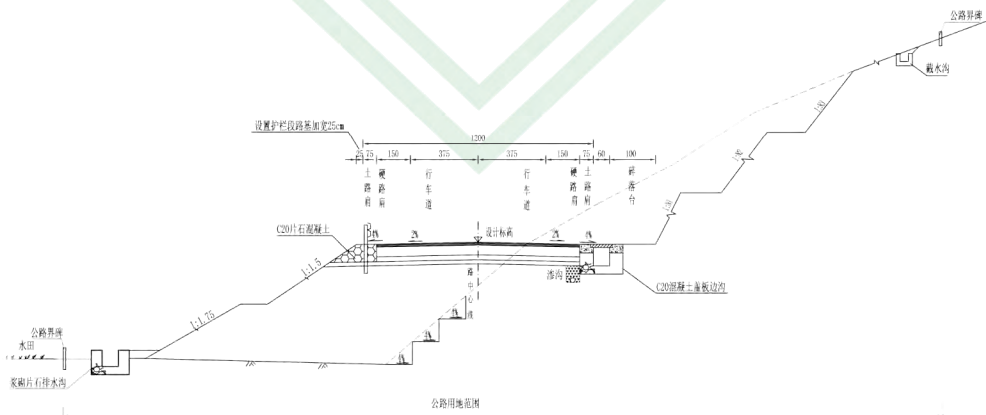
12 m宽路基标准横断面图（尺寸单位：cm）
